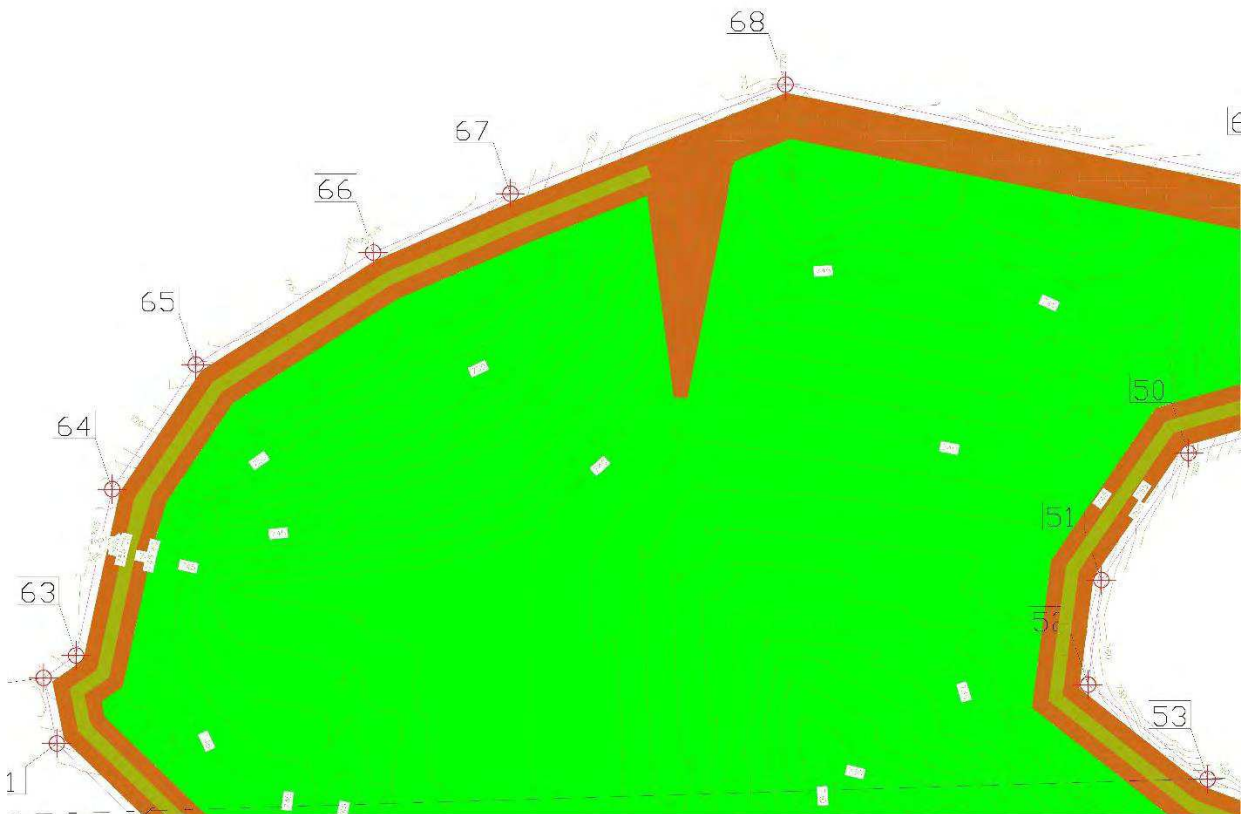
Esquema de plantación en un perfil de restauración con pinos a pie de los taludes más fuertes.
